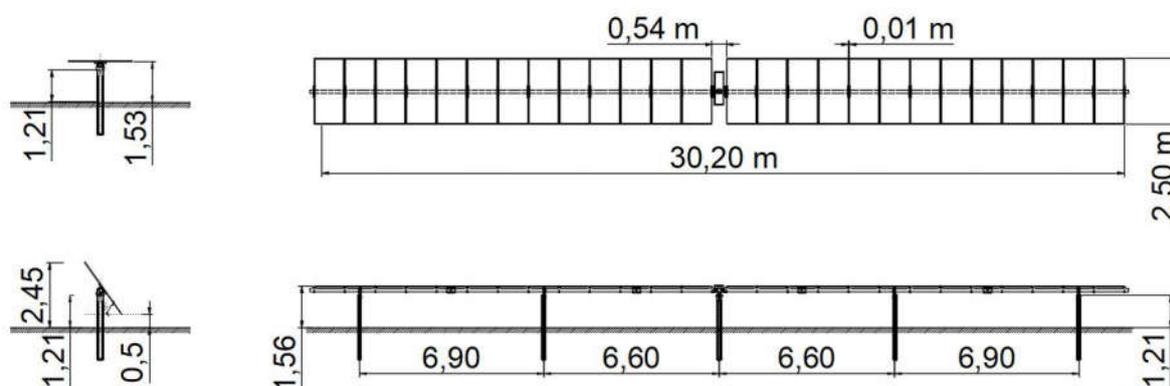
prospetto e pianta struttura di sostegno metallica dei moduli fotovoltaici
